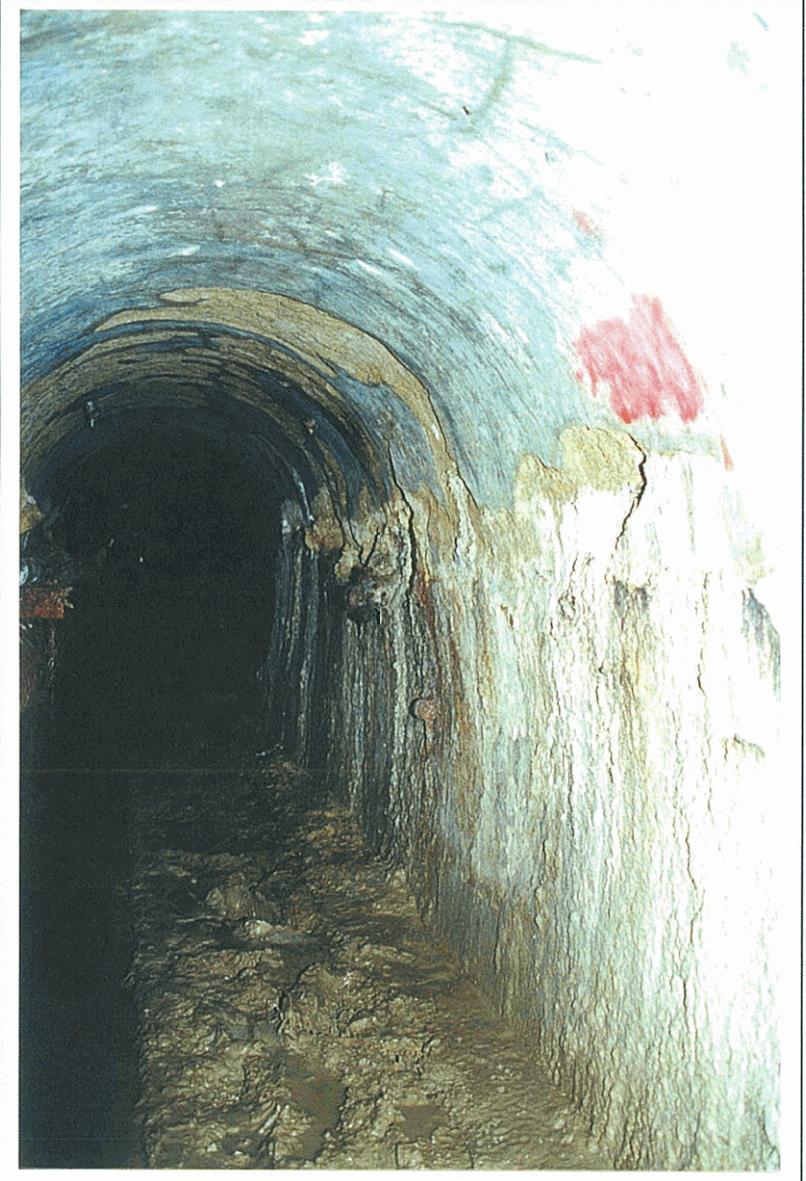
forte dégradation du revêtement en ciment de la galerie et oxydation des tubes d'injection.
